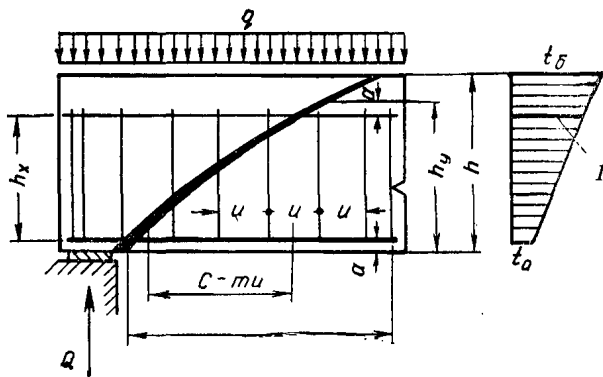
Схема расположения поперечной арматуры и развития наклонной трещины в изгибаемом железобетонном элементе при температуре нагрева конструкции, превышающей максимально допустимую температуру нагрева поперечной арматуры
